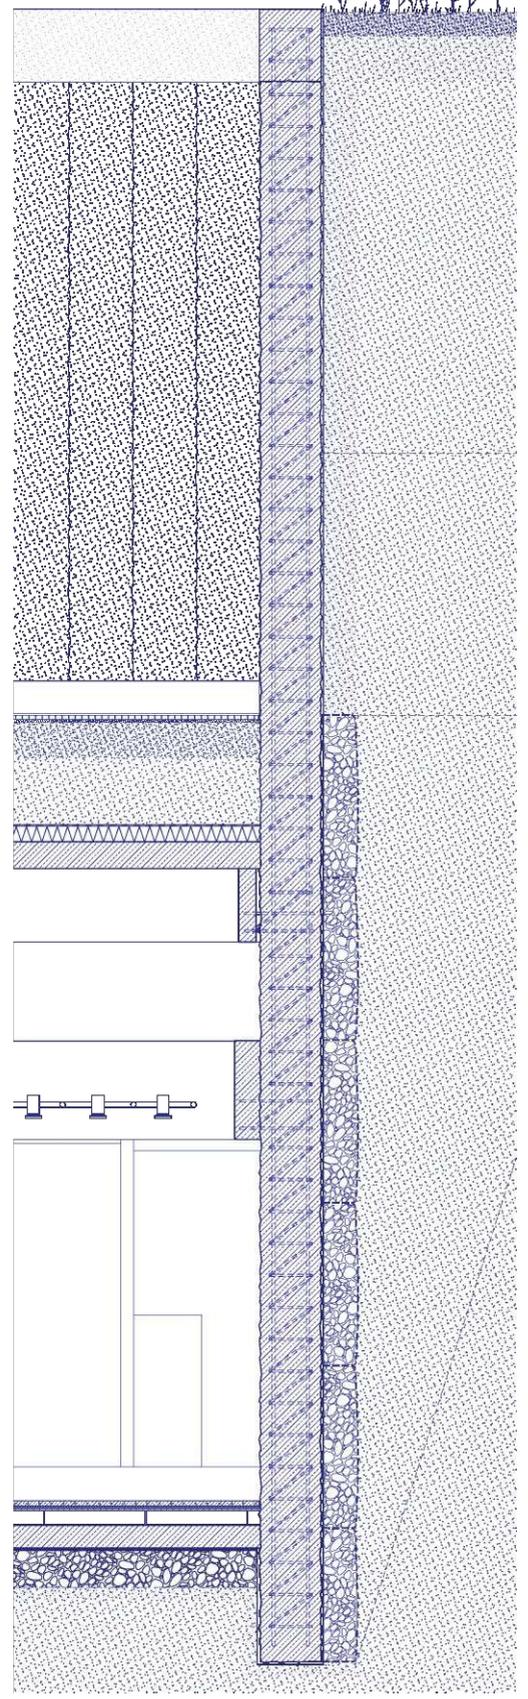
Details Längsschnitt, Teil 2, M 1:100
